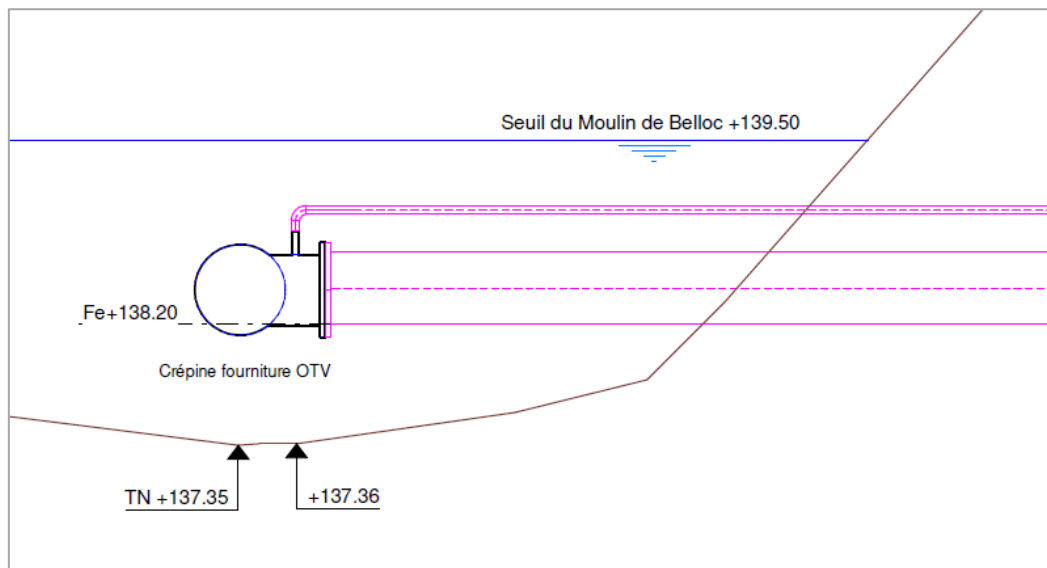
Plan de la crépine et de la conduite de la prise d'eau
